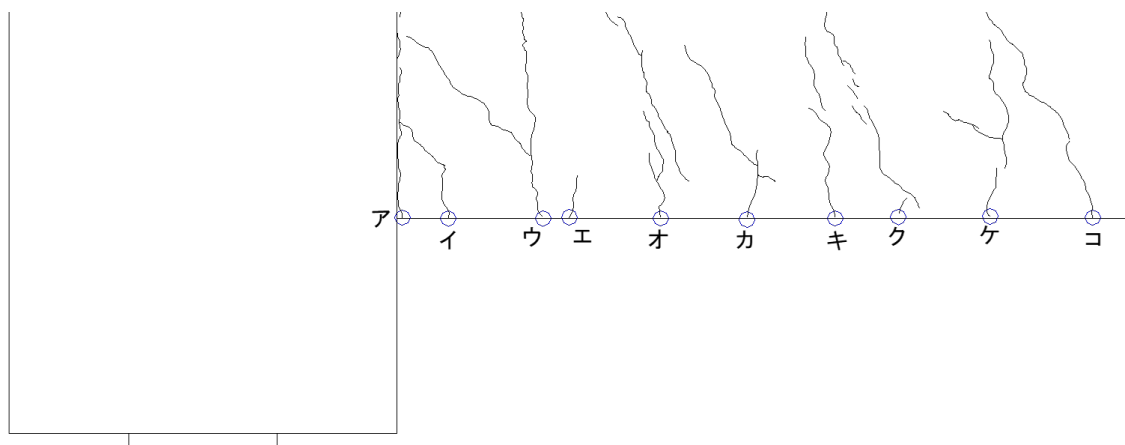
3. 226 基礎梁ひび割れ幅測定位置 (試験体 C-1 正載荷)
